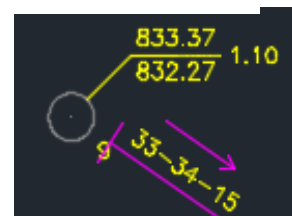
Etiquetas de PVS y tuberías en CivilCAD
